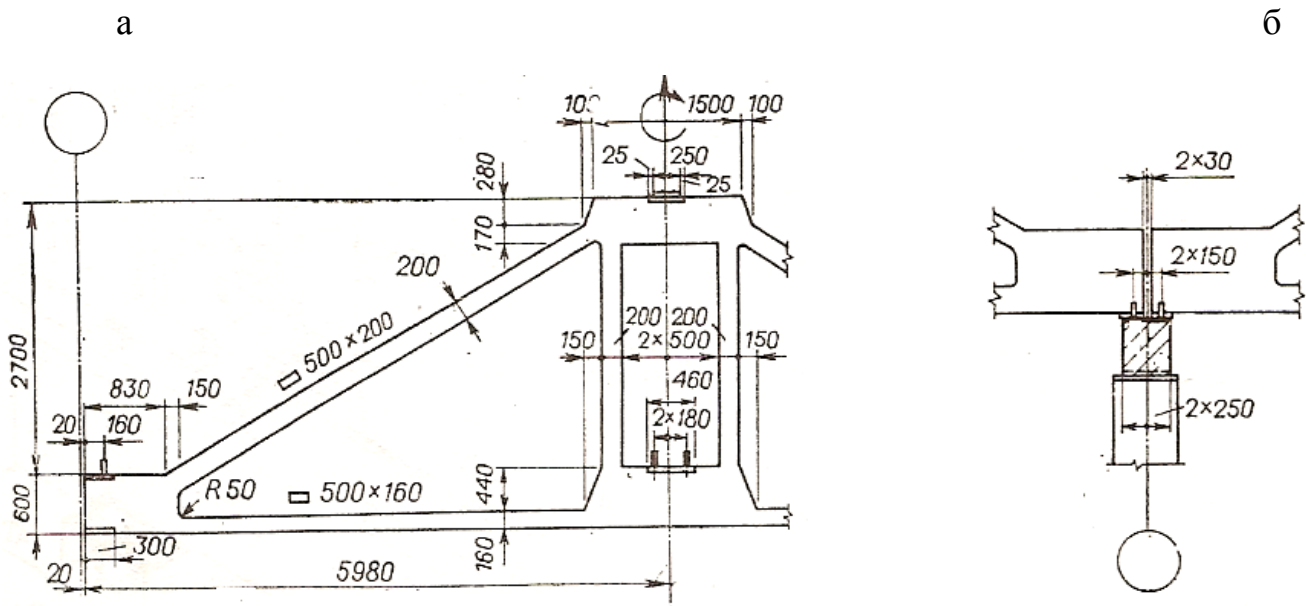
Подстропильная железобетонная ферма для малоуклонных покрытий:
